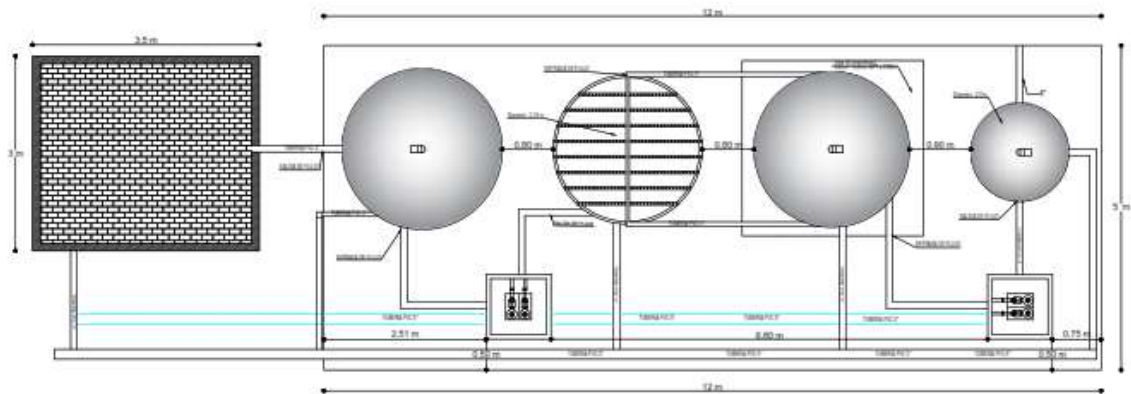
Sedimentadores primario y secundario completos para la instalación en campo. Fuente: Propia
